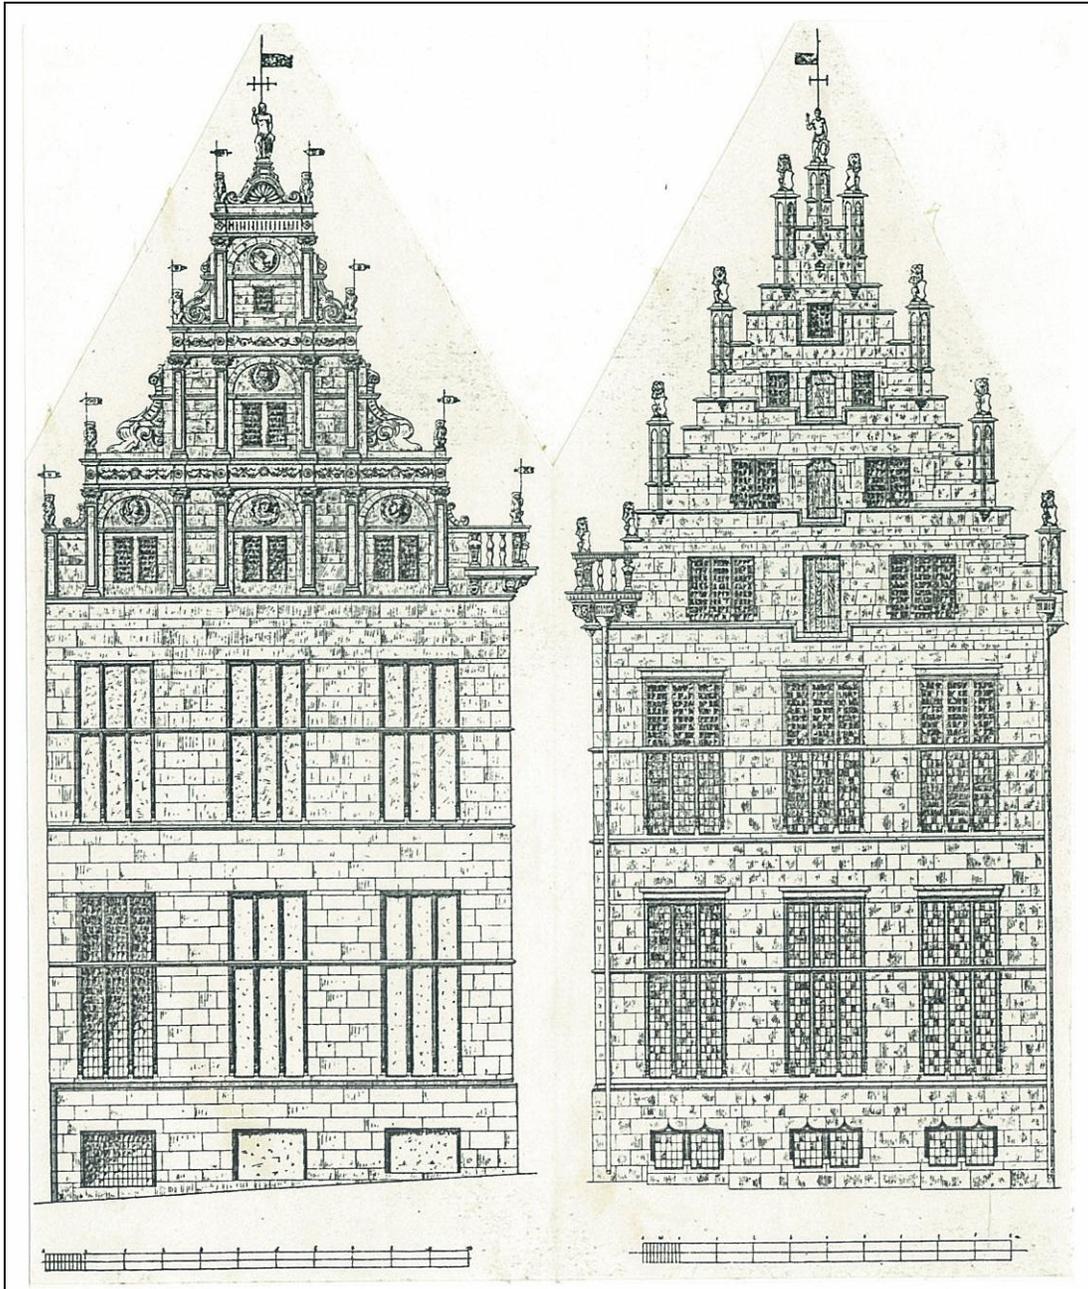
Fachadas manierista y gótica del *Schütting* de Bremen (63)
